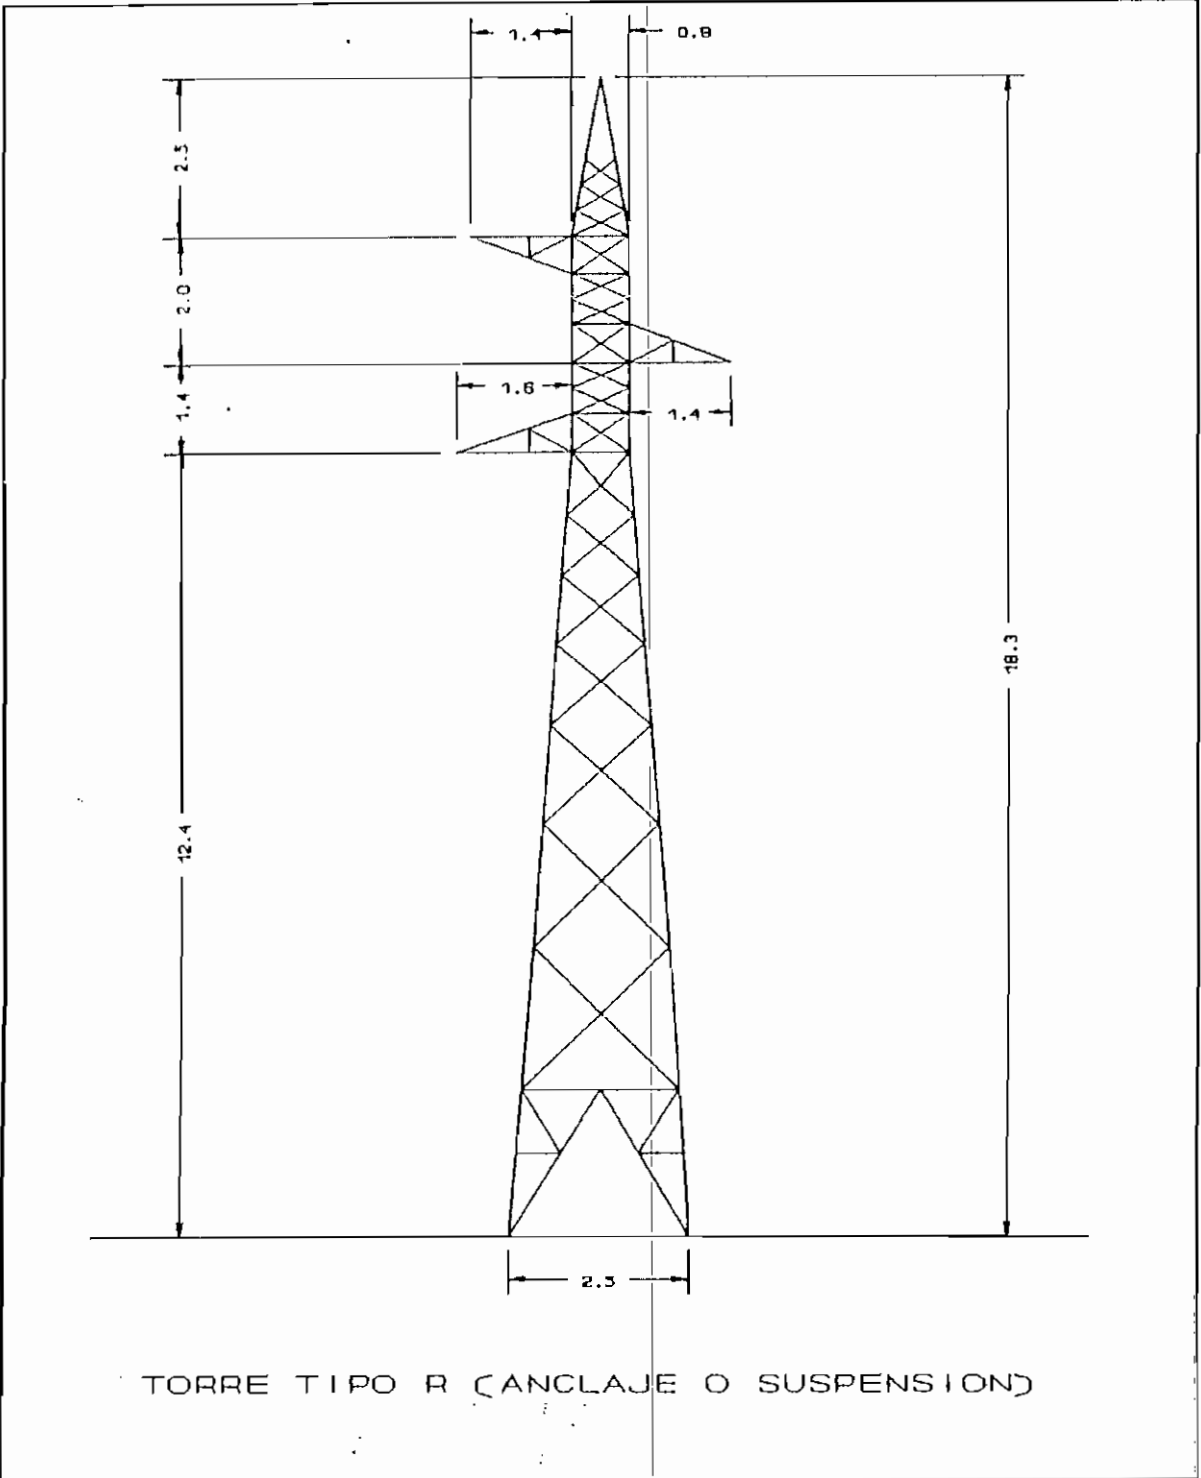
Alternativa L/T Ambato-Latacunga 138 KV, con diseño de aislamiento tipo retenida para las estructuras de suspensión
